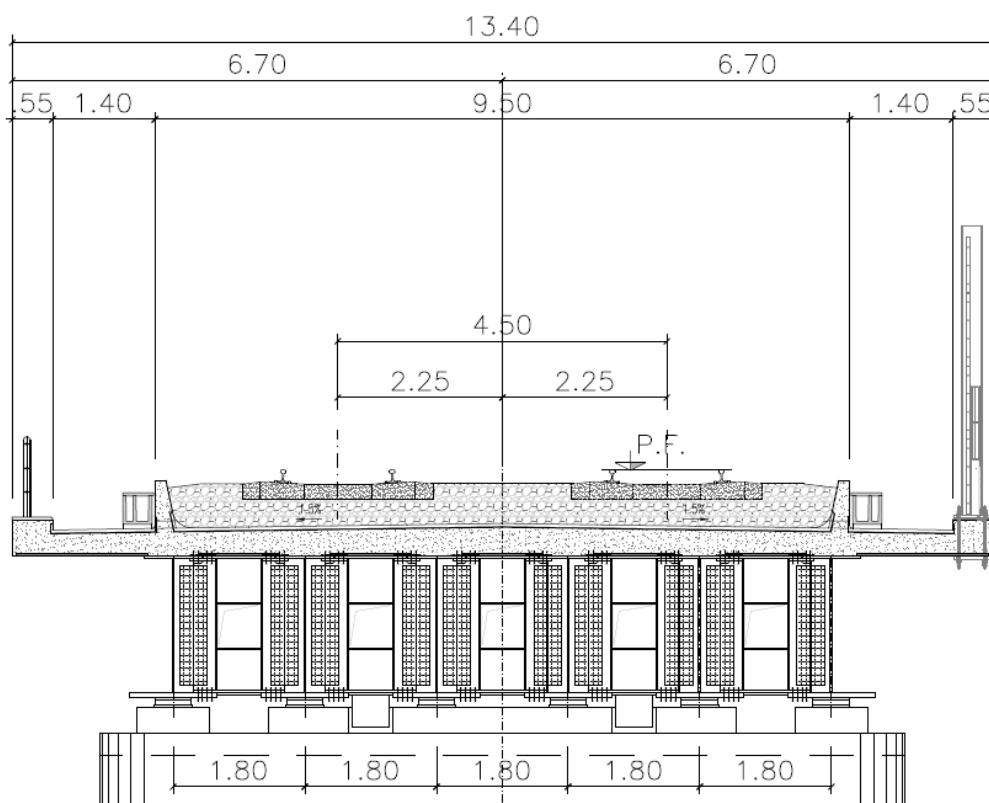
Sezione trasversale tipo dell'impalcato da 40 m.
